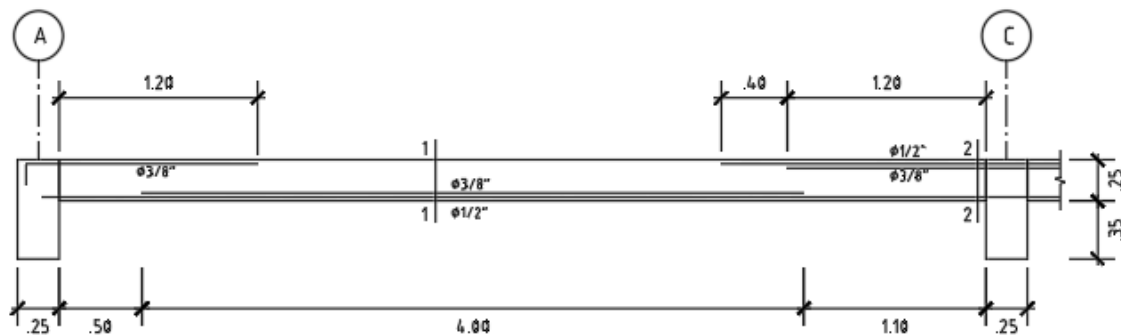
Detalle de refuerzo a flexión del aligerado entre los ejes 3-4.
